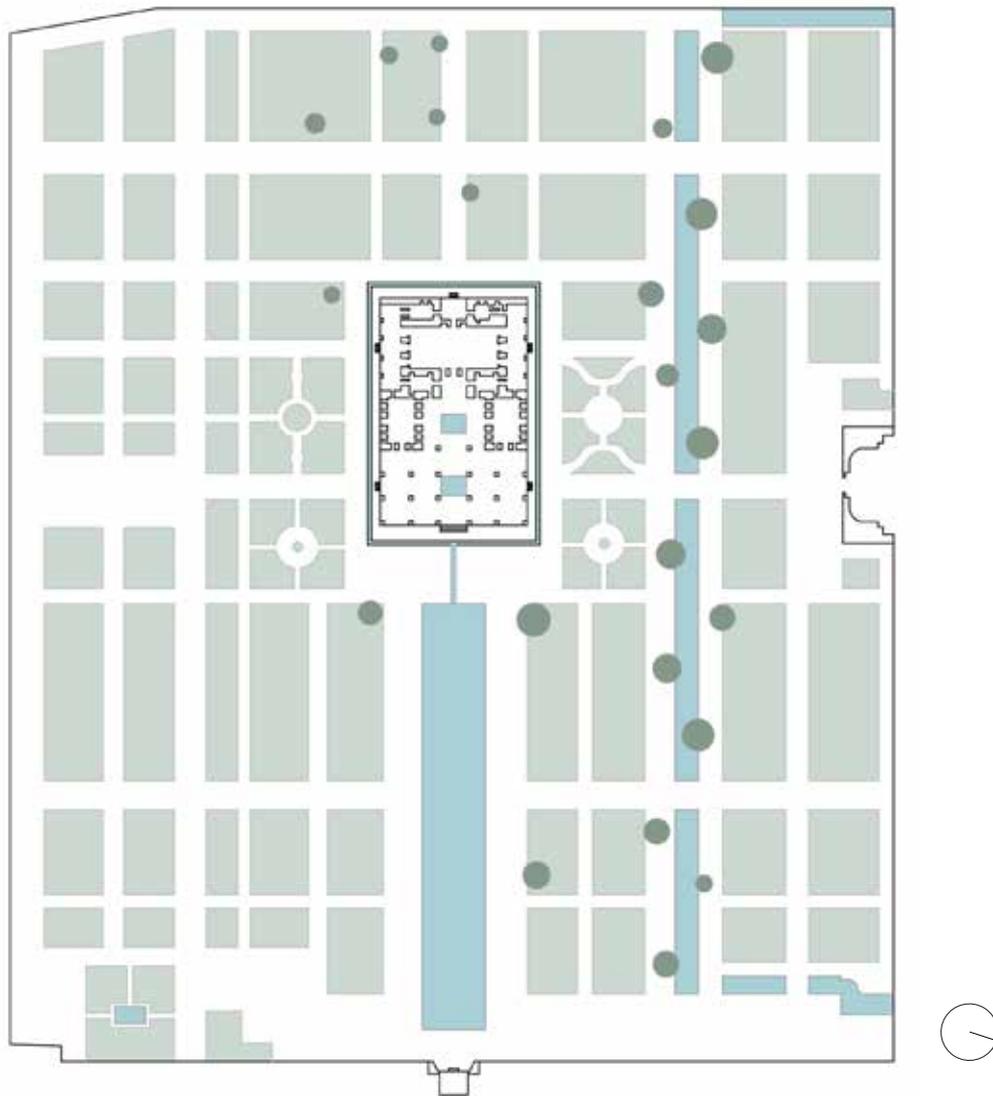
Grundriss vom Tschehel Sotun (Vierzigsäulenpalast) in Isfahan.
